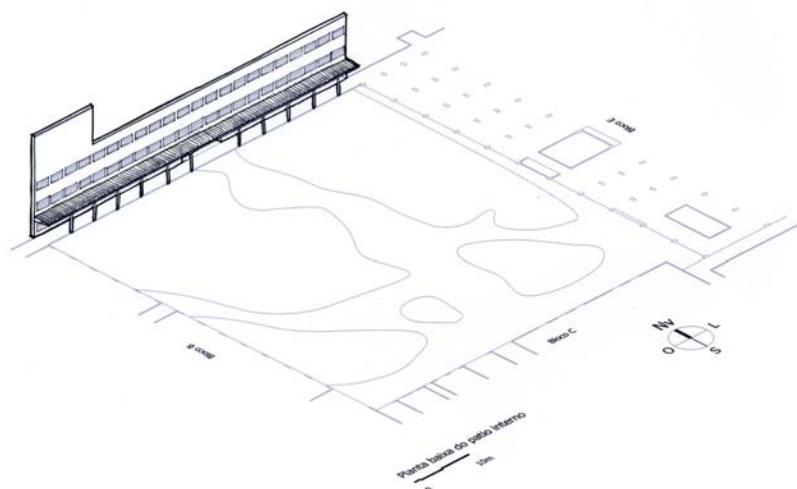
Estudo dos planos verticais, fachada Norte do pátio interno do CEFET.
